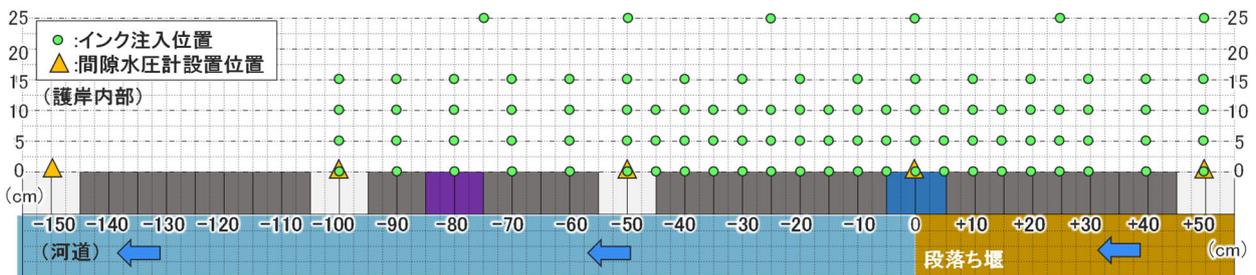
インク注入位置（段落ち堰の例）と小型間隙水圧計設置箇所平面図
